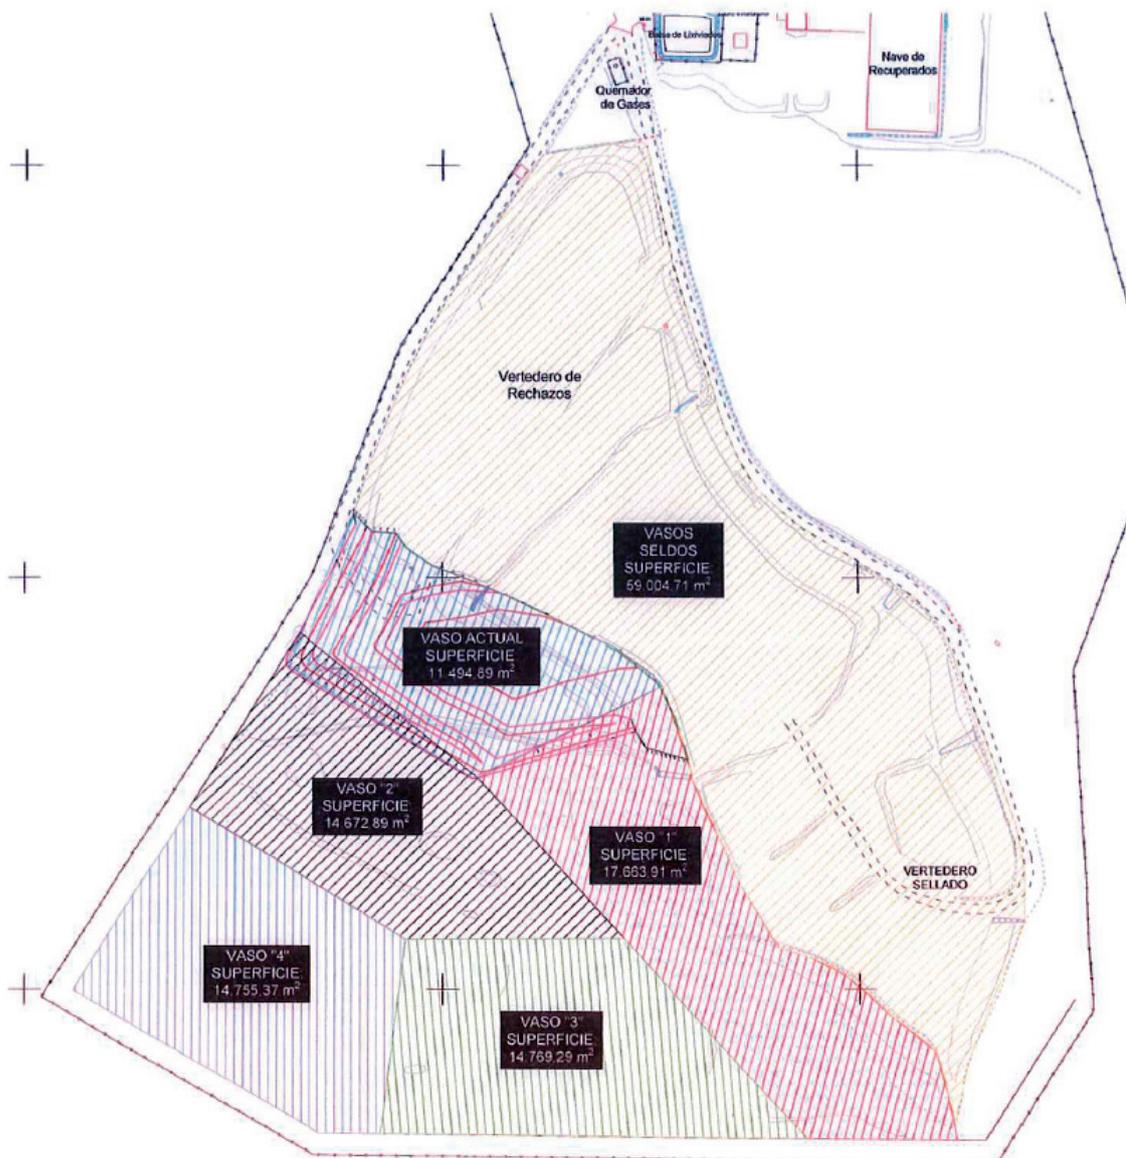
Plano 2 en planta de la instalación. Zona de vasos de vertido.
